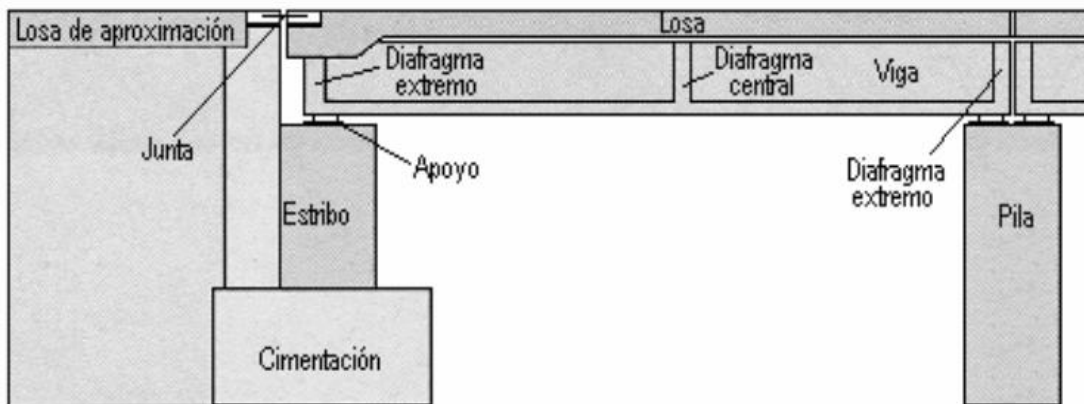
4 Algunos elementos de la subestructura y superestructura de un puente
